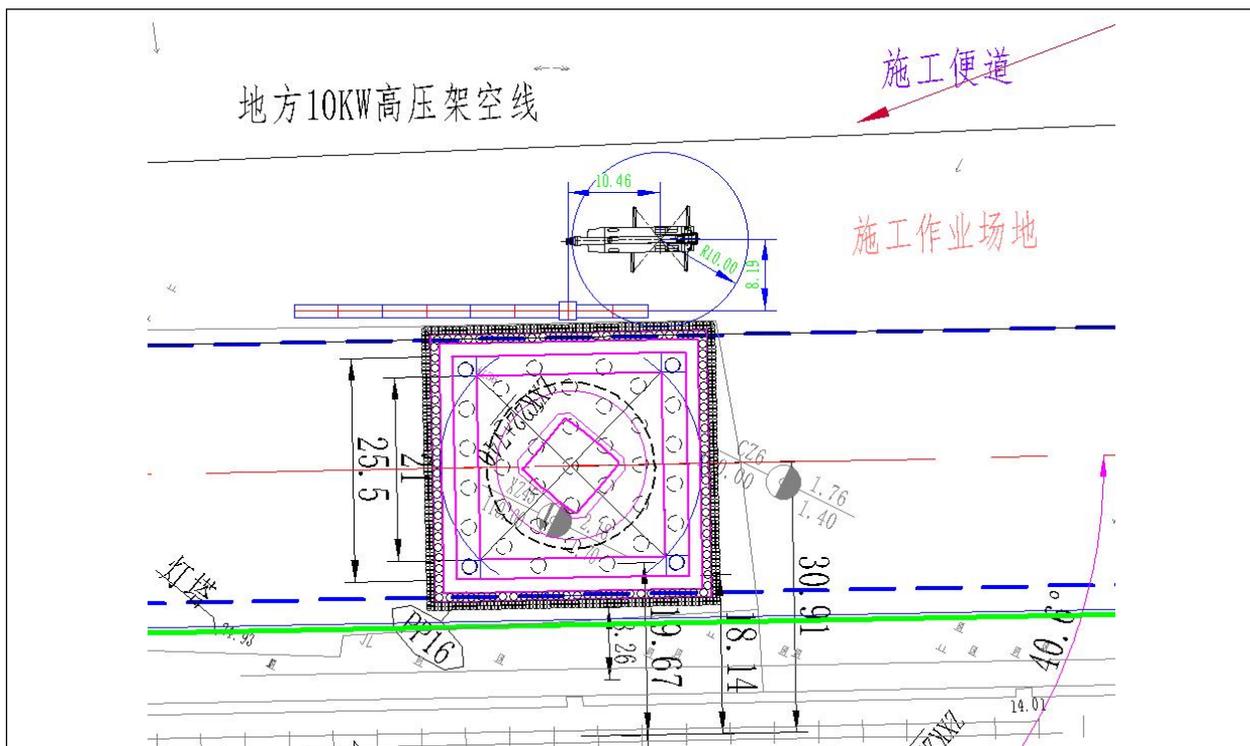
平衡臂臂节一拆除平面图（单位：m）
